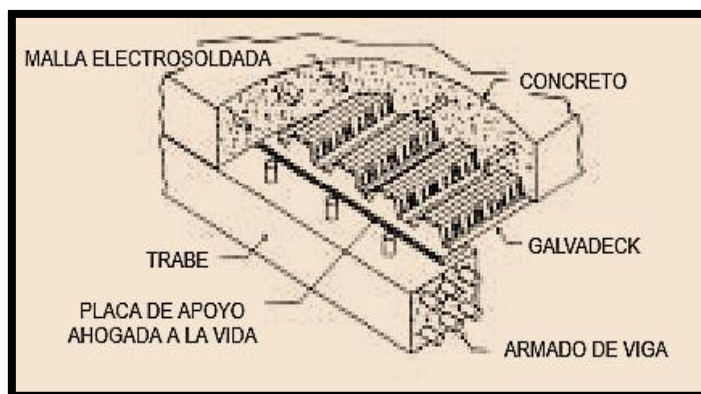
instalación en estructuras de concreto por medio de placas de anclas ahogadas.
